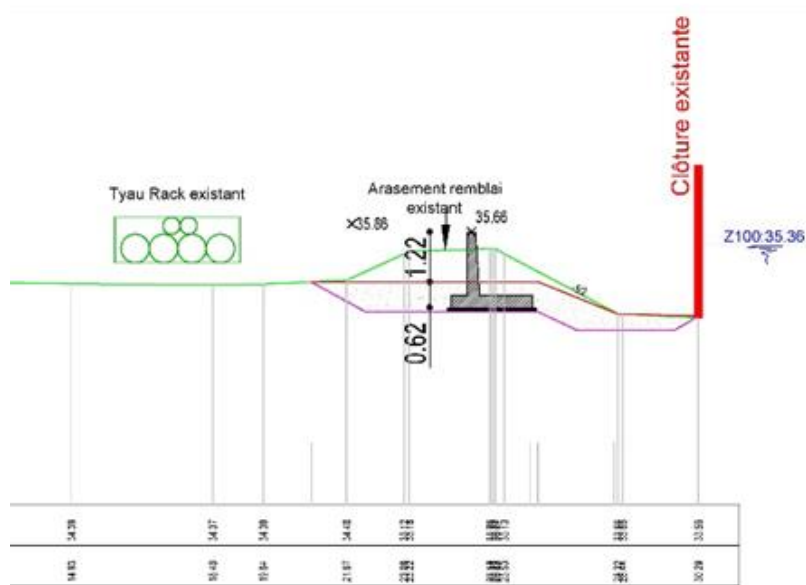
Profil en travers du mur 2 au PK 10.
